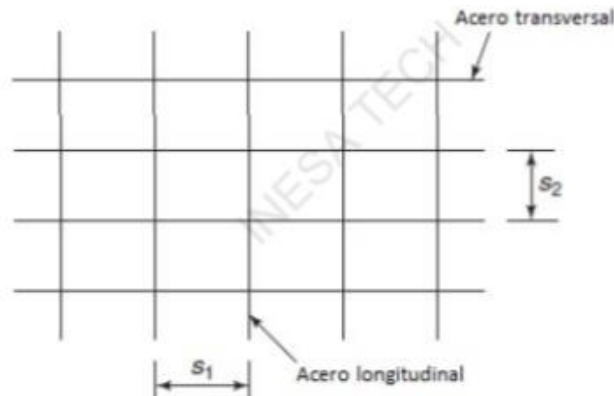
Acero longitudinal y transversal para el armado del muro estructural
